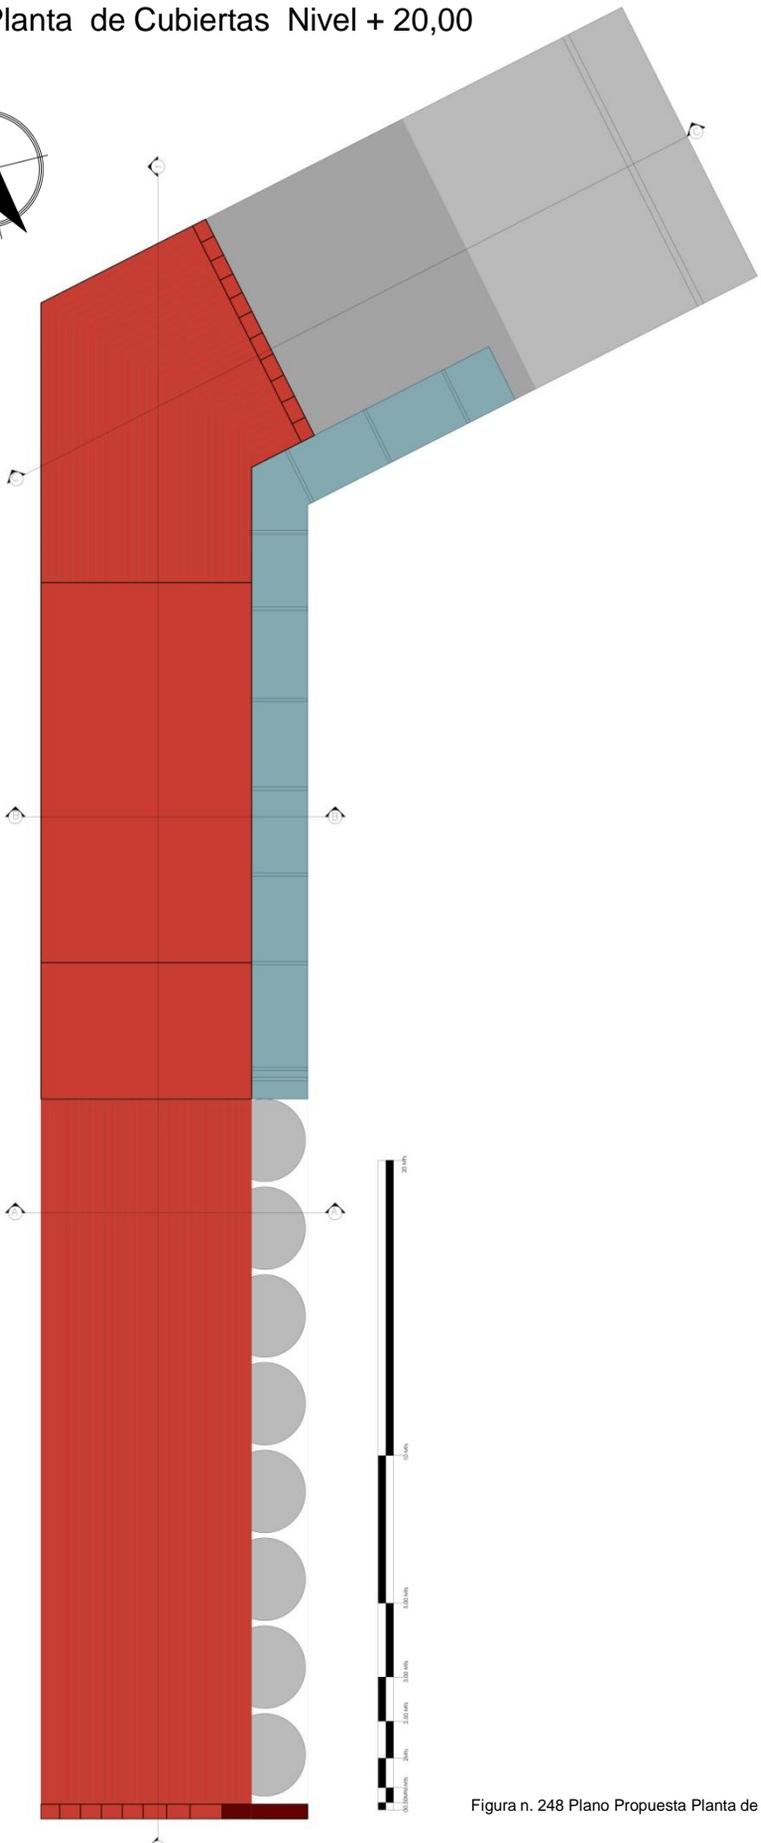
Plano Propuesta Planta de Cubiertas Centro Cultural
